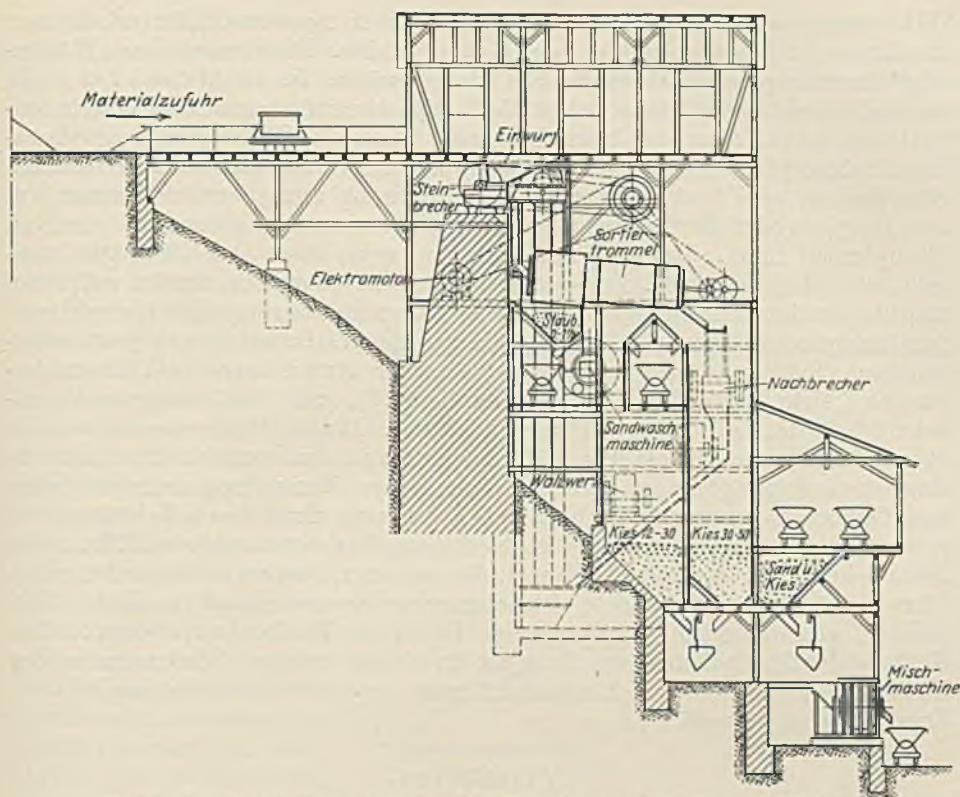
Betonbereitungsanlage der Ibag für den Bau einer italienischen Talsperre.
